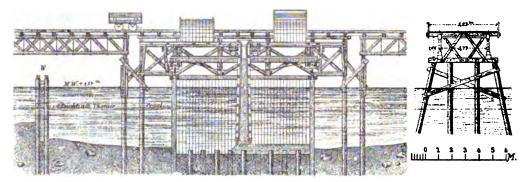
Längenschnitt. Versenkung des Betons bei den Strompfeilern der Weichselbrücke.
